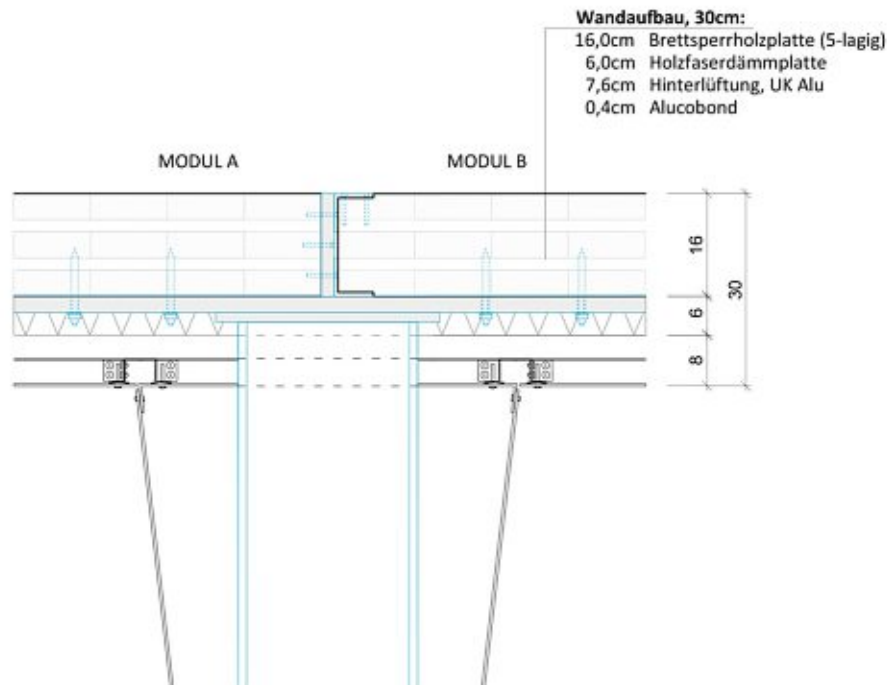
Verbindung Bauelemente zu einem Modul (Werkseitig)
